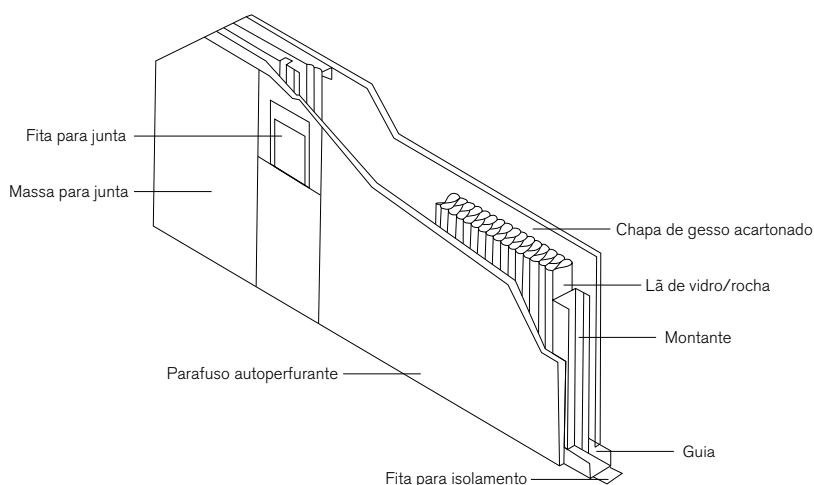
Desenho de montagem de divisória *drywall* com preenchimento entre placas de material acústico. Fonte: <<http://www.isoline.com.br/wp-content/uploads/2010/01/Sistema-Drywall-Isoline.jpg>>.
